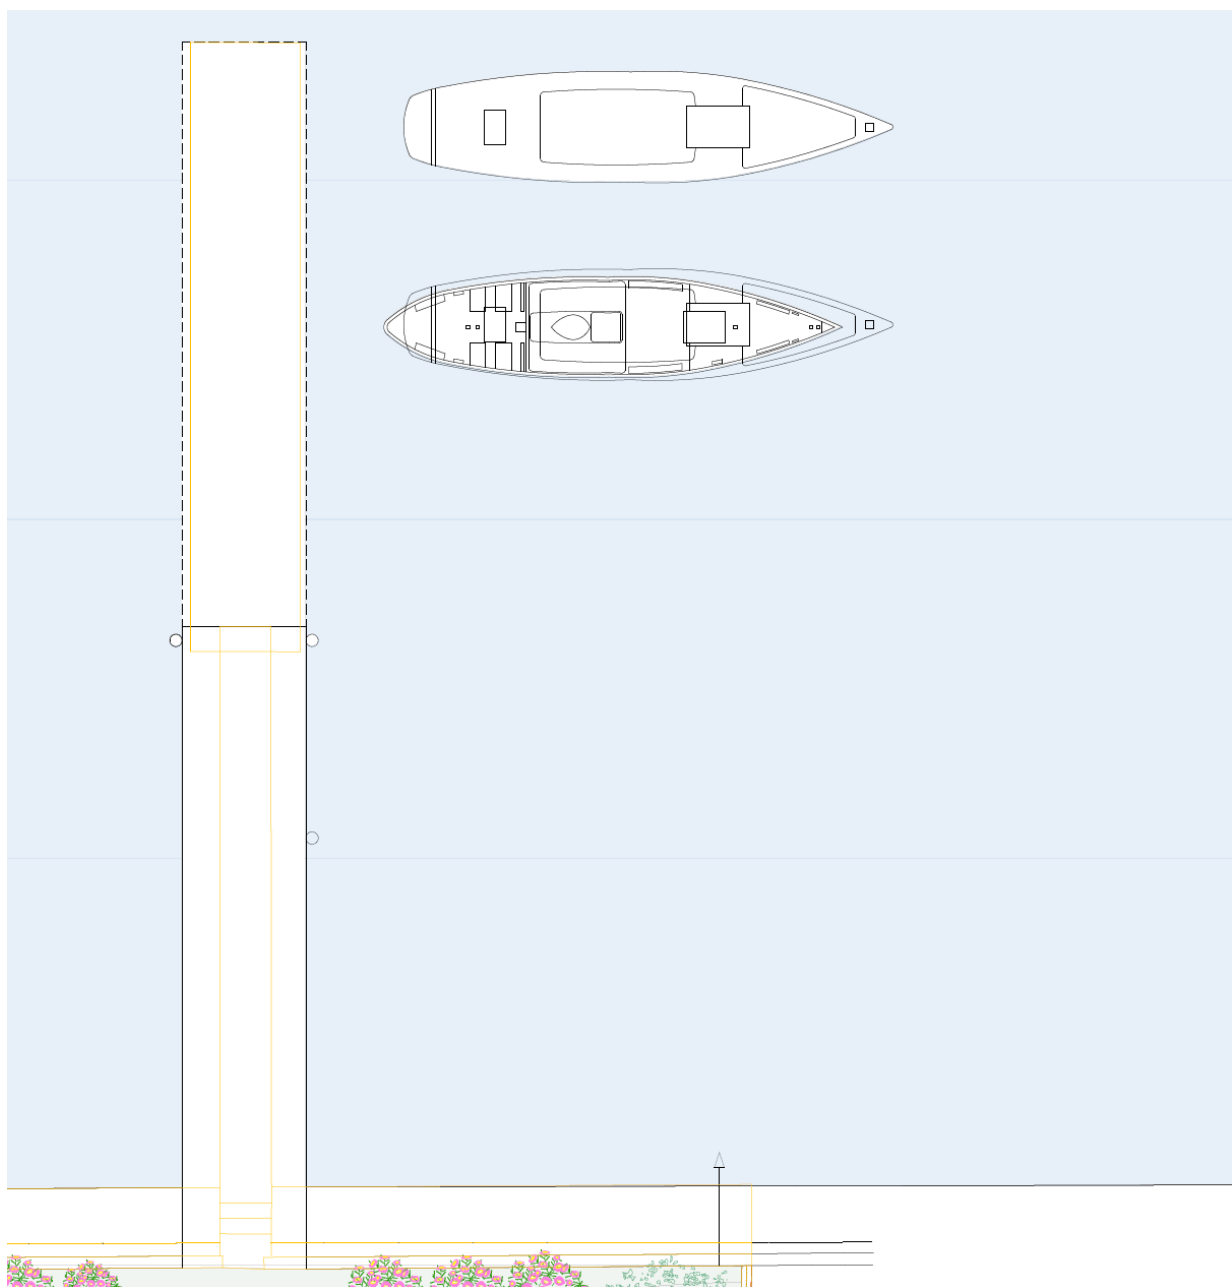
Schema adeguamento pontile. In giallo viene raffigurato il pontile esistente .
